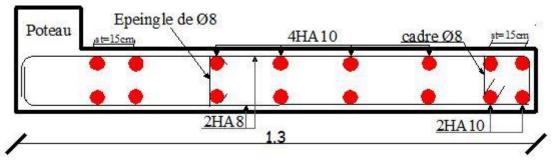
Schème de ferraillage de voile $V_{X1.}$
